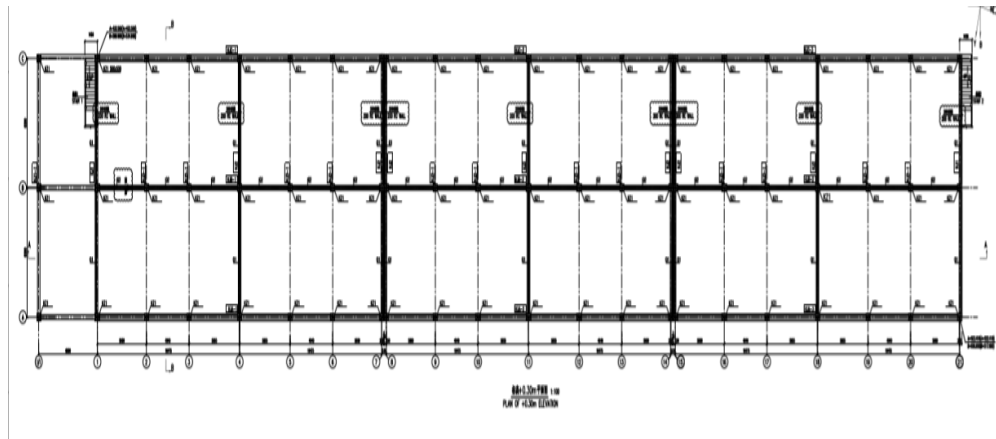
Planta dos níveis -2,30 e 0,30 m da torre de arrefecimento da CCC do Soyo.
